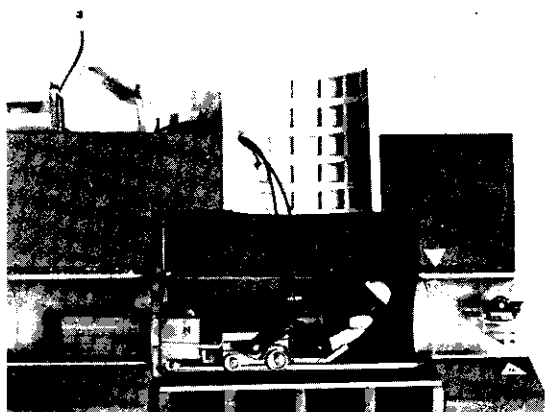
Maquete onde se vê a posição do Laser instalado no poço de serviço.
